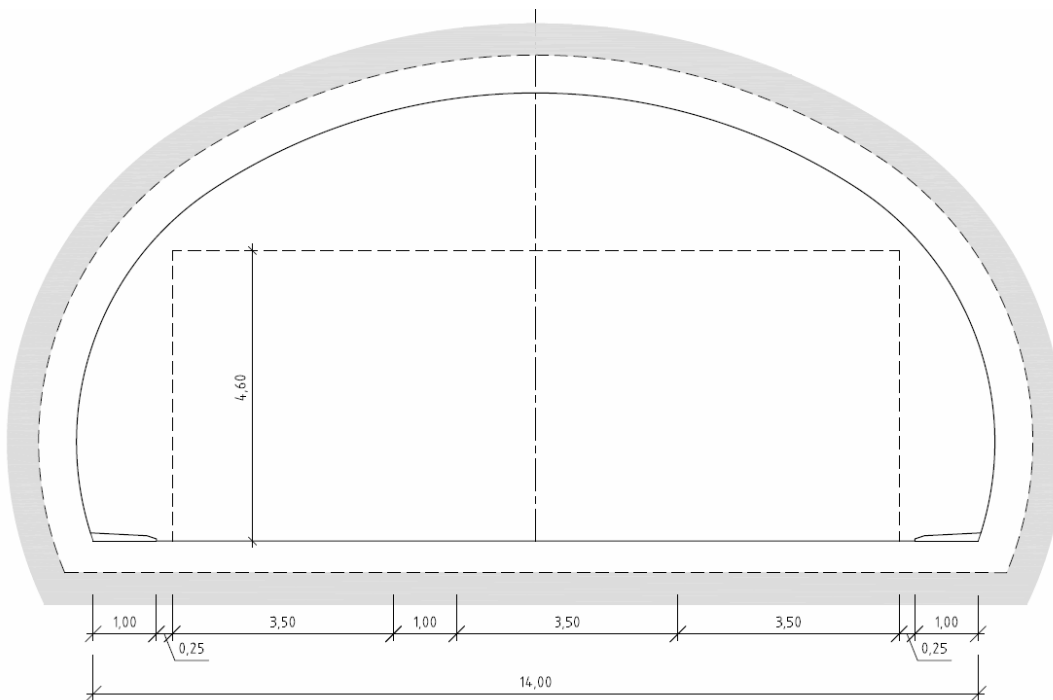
Tunnelprofil T10,5 (mål i m)
